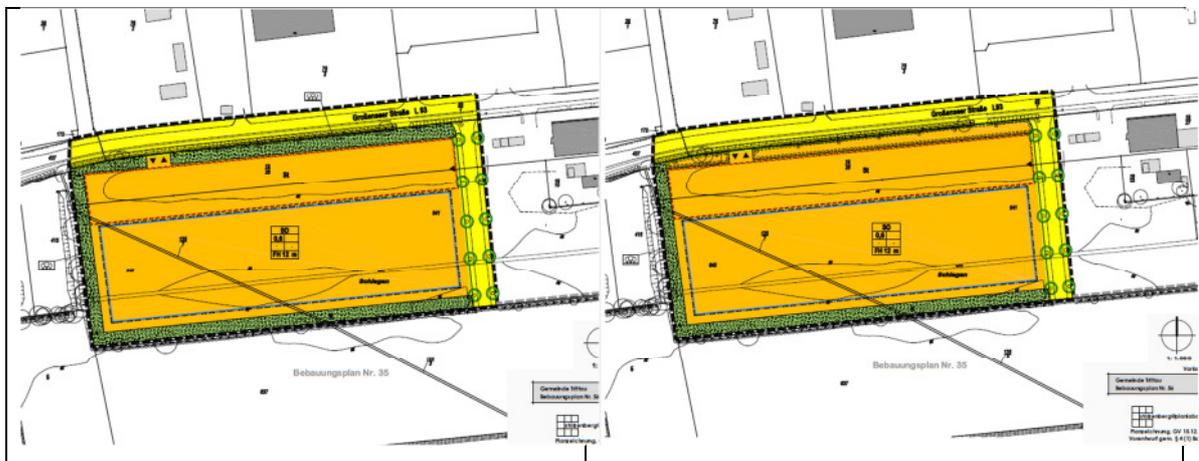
B-Plan Nr. 56 mit zwei Varianten (Stand 15.12.2016)
